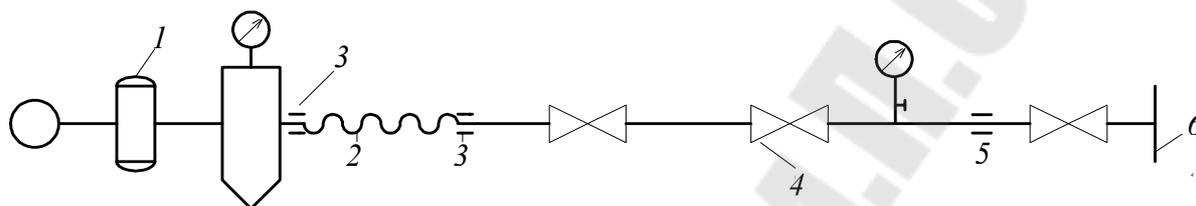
Схема присоединения трубопроводов для промывки:
